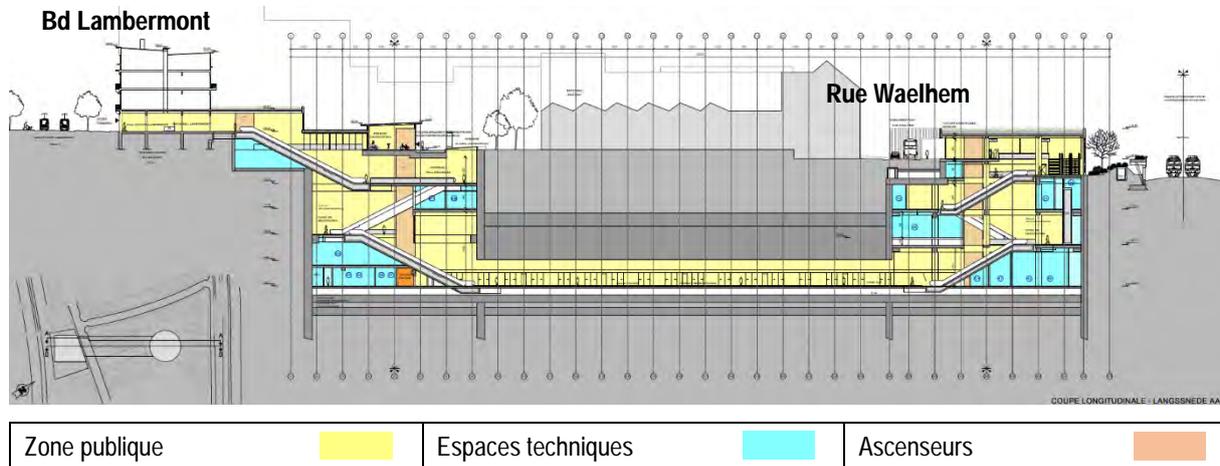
Station Verboekhoven, coupe longitudinale (BMN, 2018)
